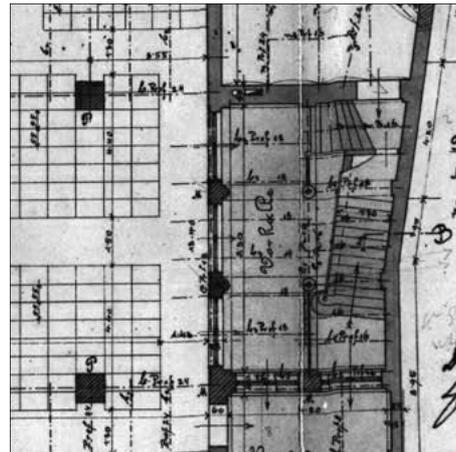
Grundriß Erdgeschoß im Bereich der Galerie
